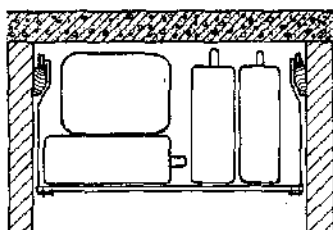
Вариант передвигающихся антресолей: 1 — опорный брусок; 2 — подвеска из металлической полосы; 3 — шуруп; 4 — ролик; 5 — полозок
